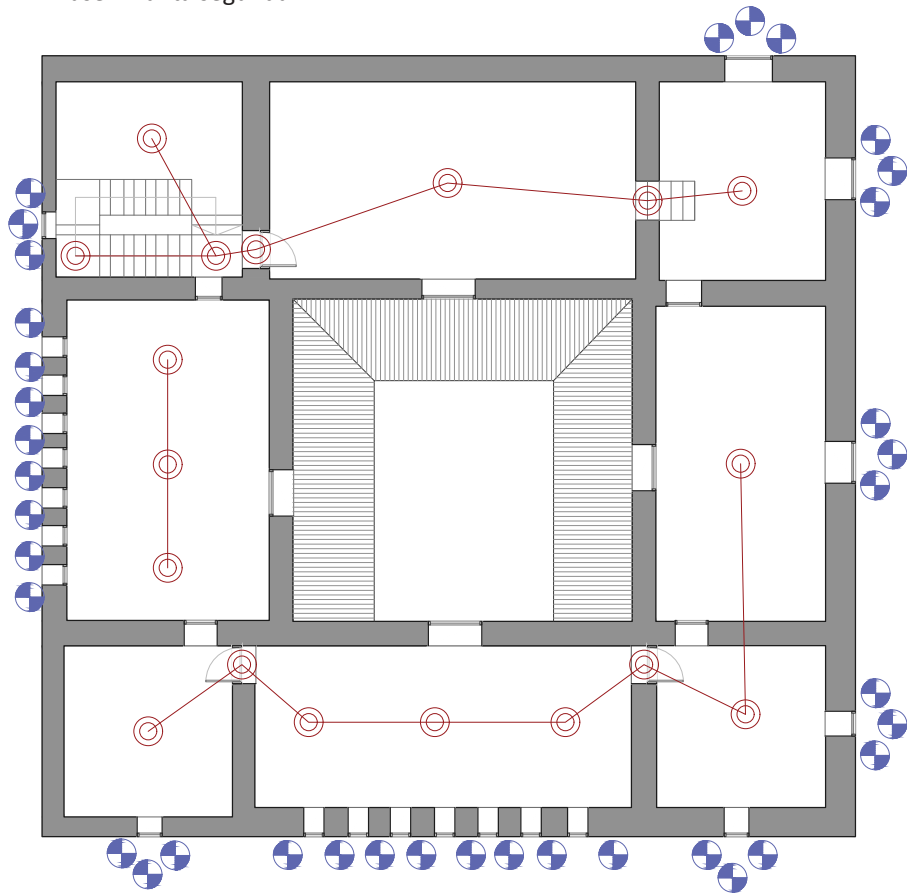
Esquema recorrido vuelo con dron. Planta cubierta
